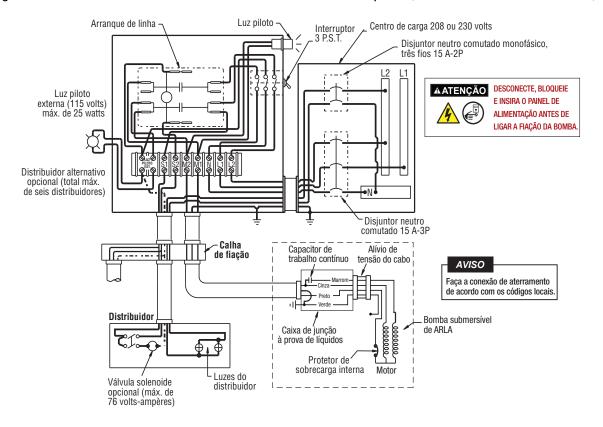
Caixa de controle remoto de 230 VCA com bobina de 110 VCA - modelo 880-041-5
